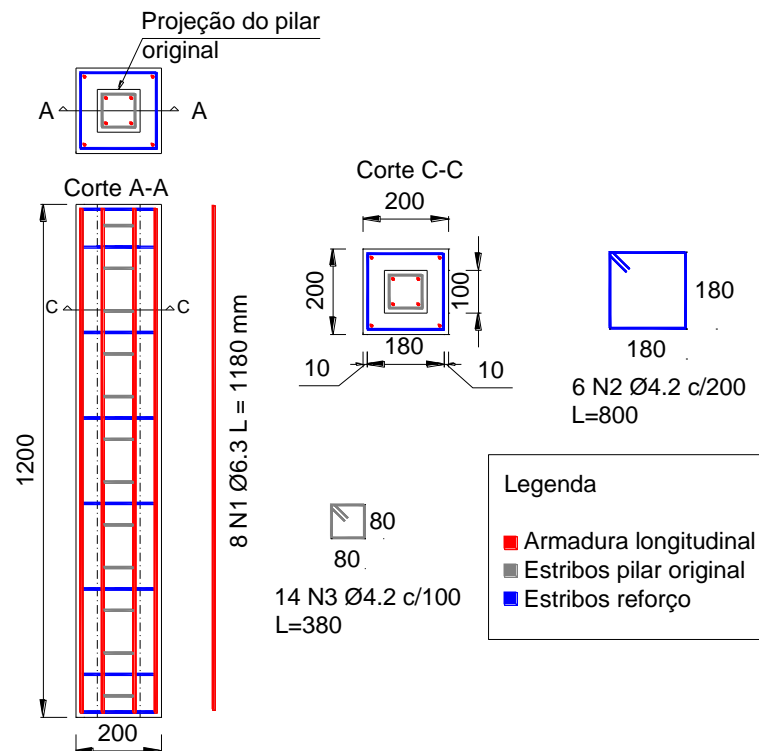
Detalhamento das armaduras dos pilares de referência
